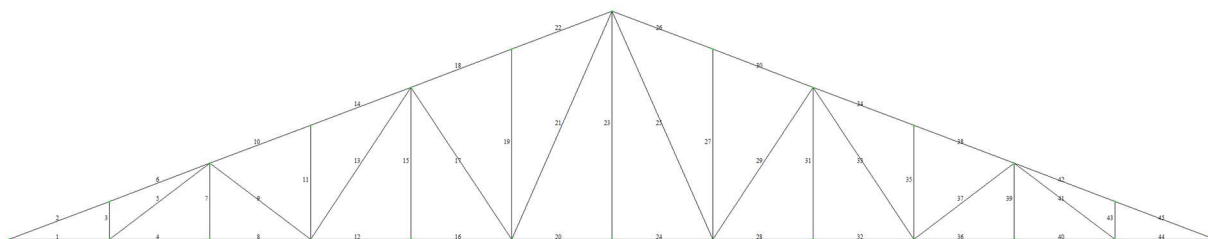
Расчетная схема фермы с нумерацией элементов
